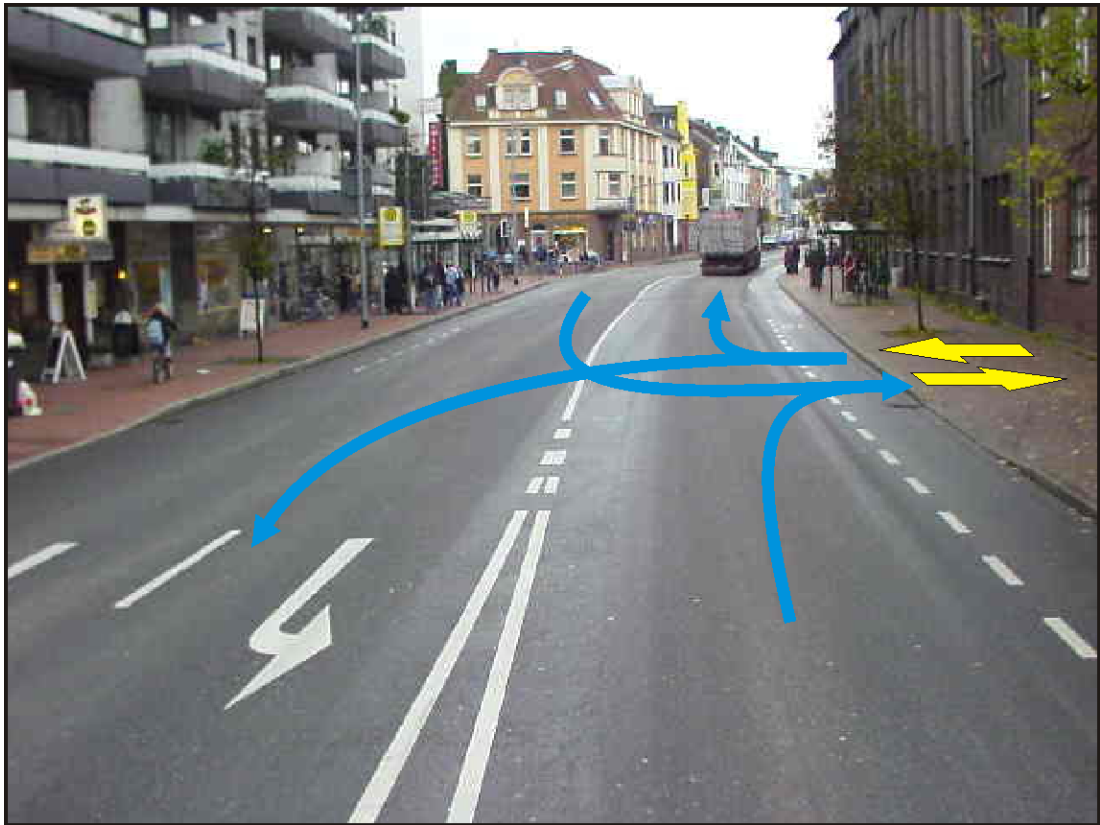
Zufahrt Tiefgarage Hochdahler Straße
